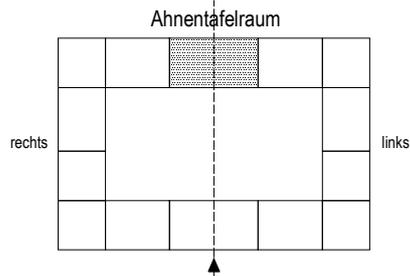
Grundriss-Schema des Geschlossenen Wohnhofs
